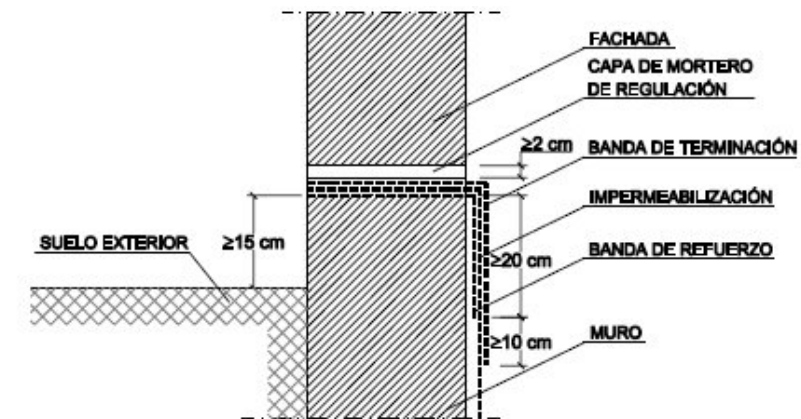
Ejemplo de encuentro de un muro impermeabilizado por el interior con lámina con una fachada
